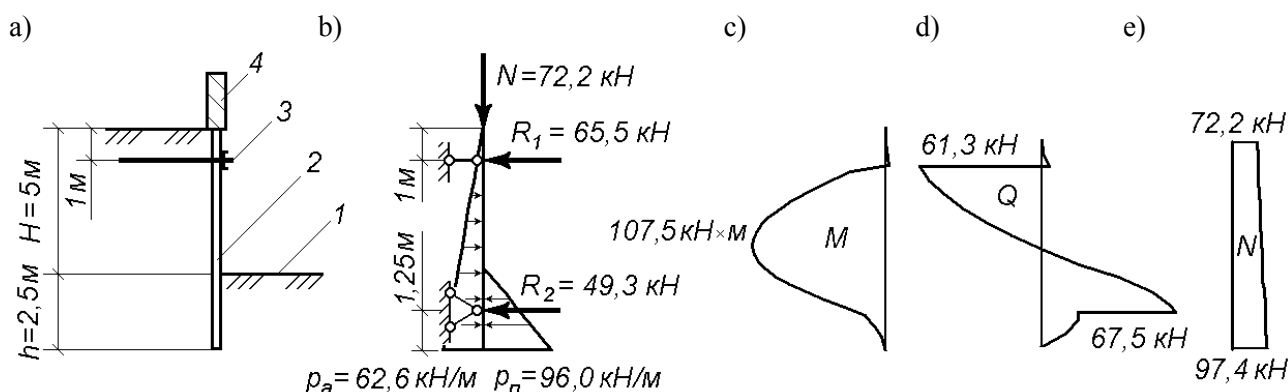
Крепление стенок котлована шпунтовым свайным рядом без анкерровки:
